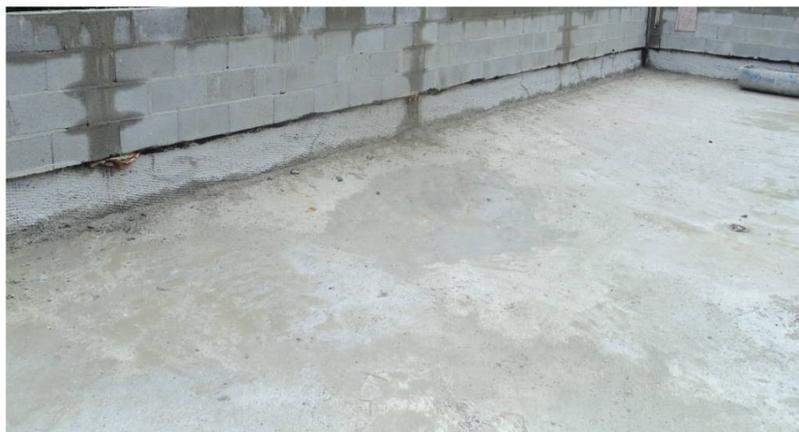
Preparação para a implantação do telhado verde, Construtora C.
